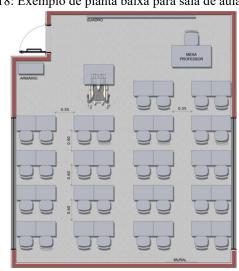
Exemplo de planta baixa para sala de aula - FNDE
